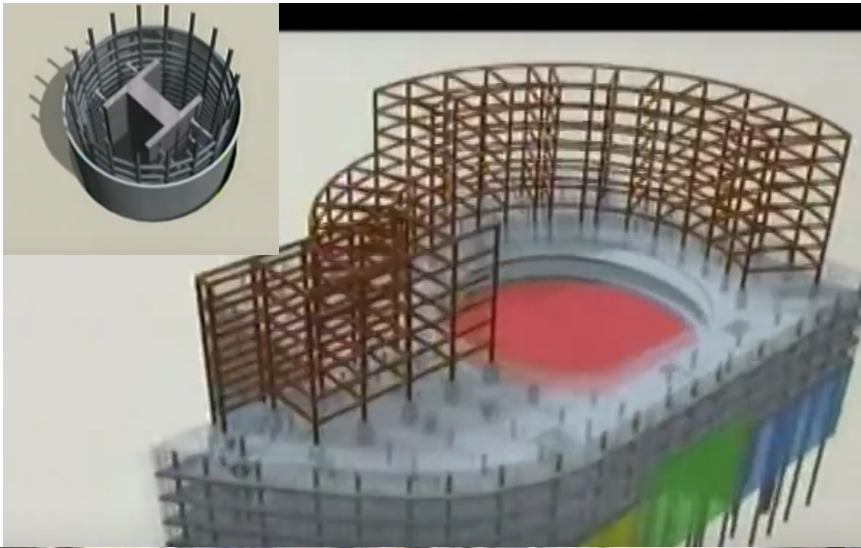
, 26 y 27 La nueva sede del Senado en México. <https://www.youtube.com/watch?v=XGmSJP6FZtM>
